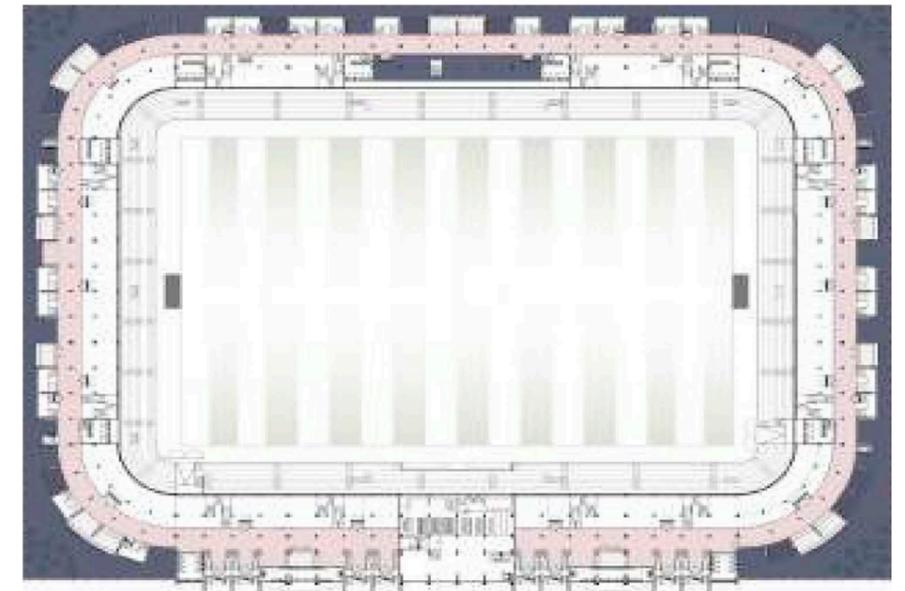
Planta del estadio, donde se puede apreciar el recorrido perimetral de accesos.
